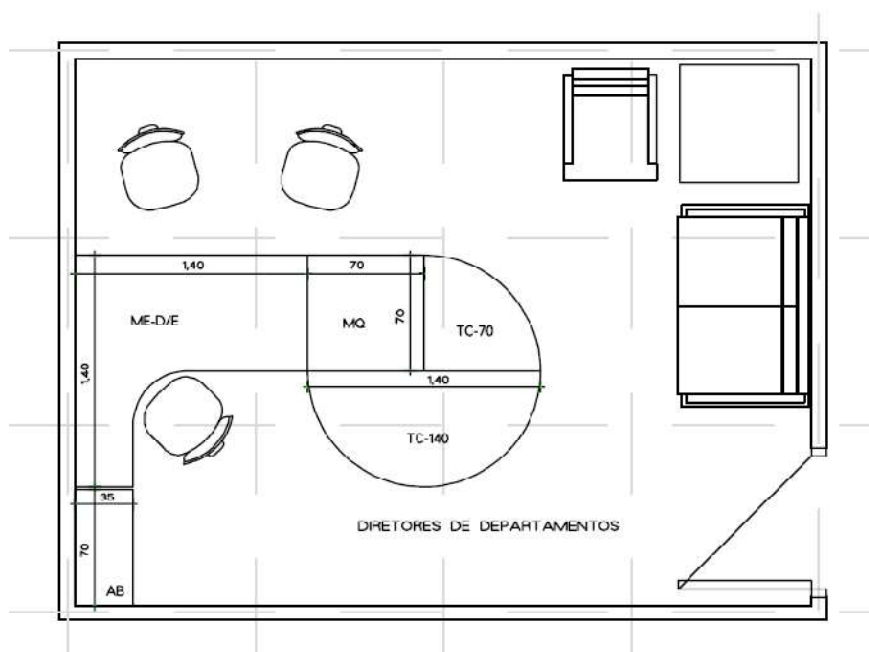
Planta baixa sala Diretor de Departamento. Área aproximada: 15m² (Fonte: Plano Diretor do CAFF)
